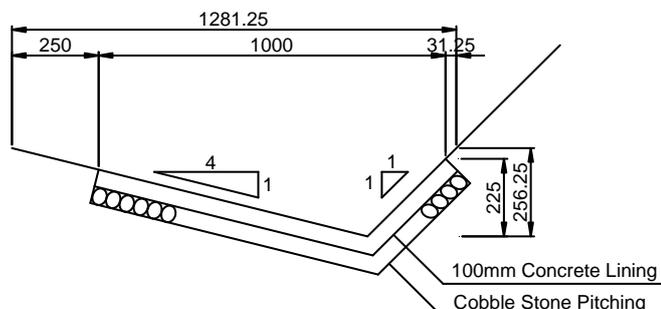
Proposto Fosso Alinhado de Betão.
